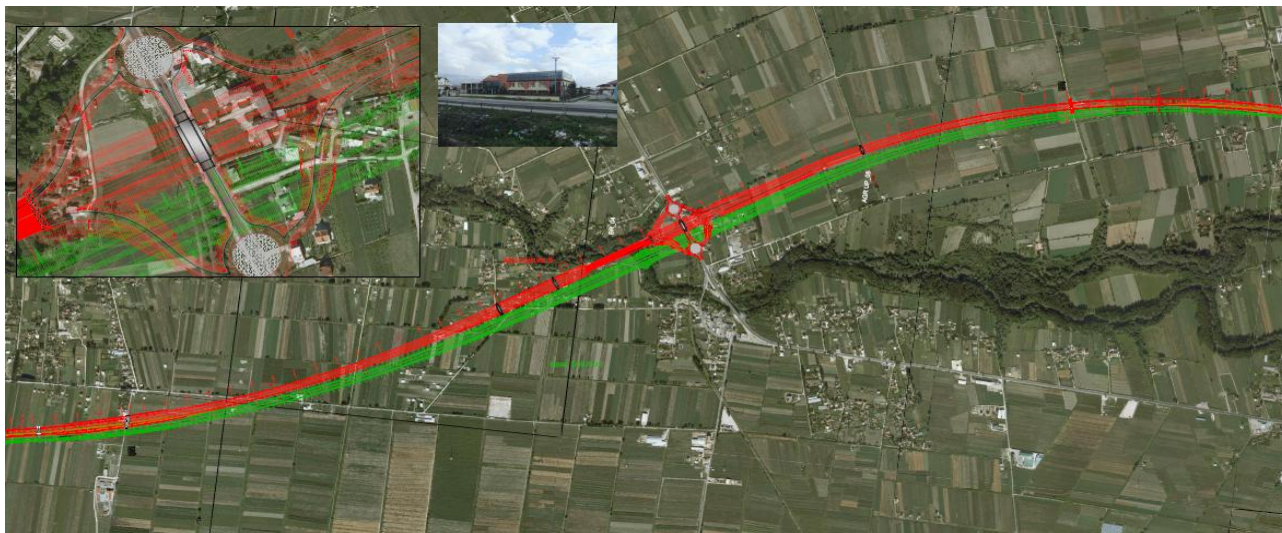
Alternativa B dhe zgjidhja baze – Planimetri
